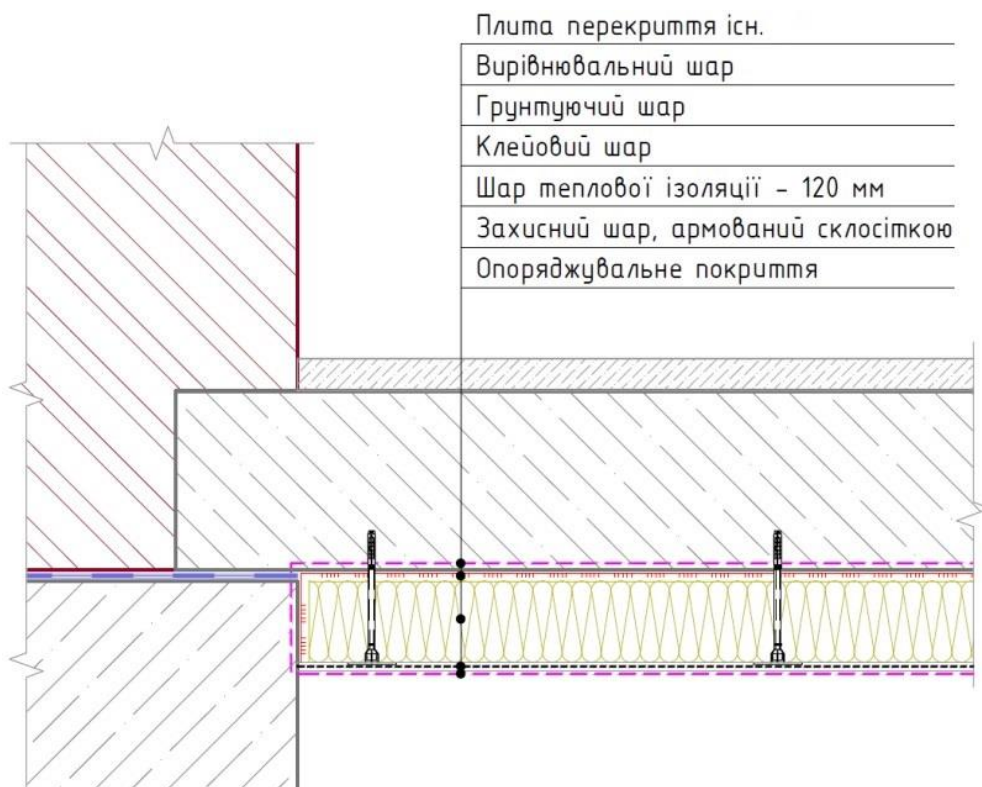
Теплоізоляція перекриття над неопалювальним підвалом
